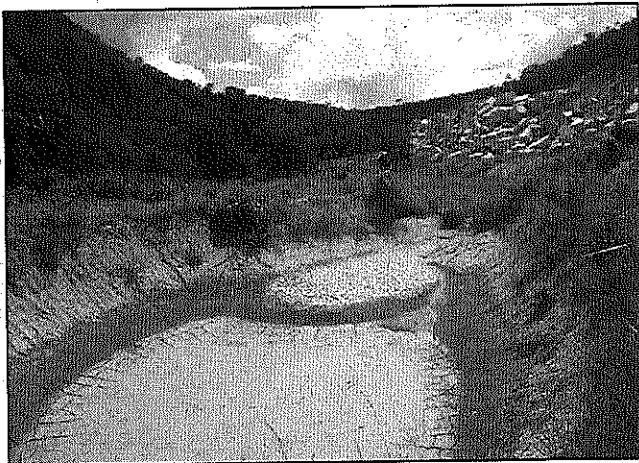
Aos fundos, vista parcial da pilha de estéril/rejeito. Em primeiro plano, caixa de contenção de água pluvial.
